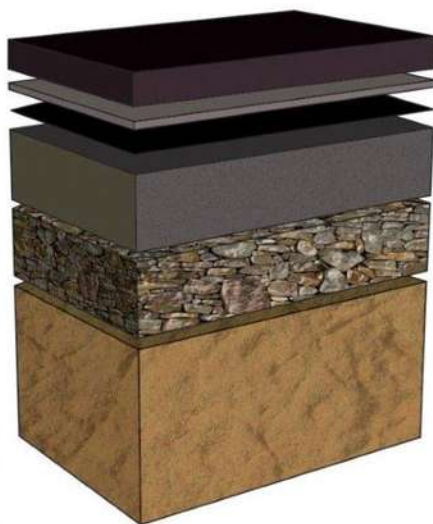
Estructura del pavimento (Fuente: Coria, Carlos., 2019)
